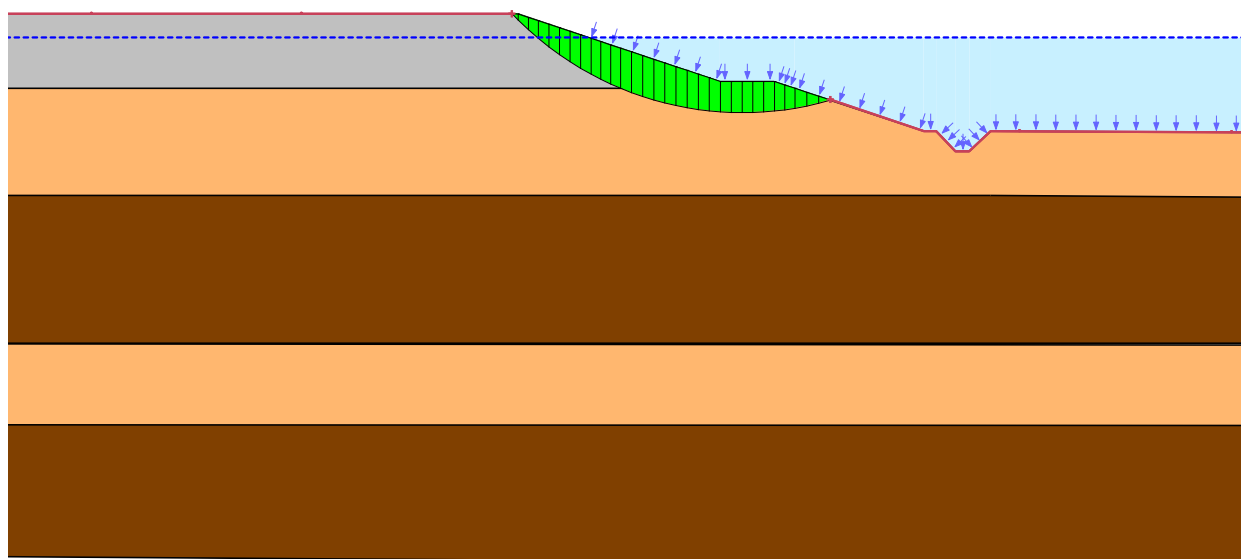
Stabilità in condizioni statiche - Sezione di calcolo Scavo Lato Sud – vasca piena
